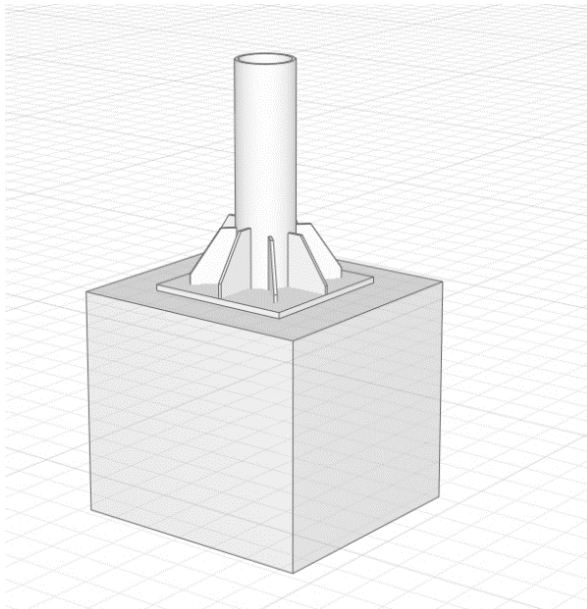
Узел сопряжения металлической колонны трубным сечением к железобетонному фундаменту «под стакан»
